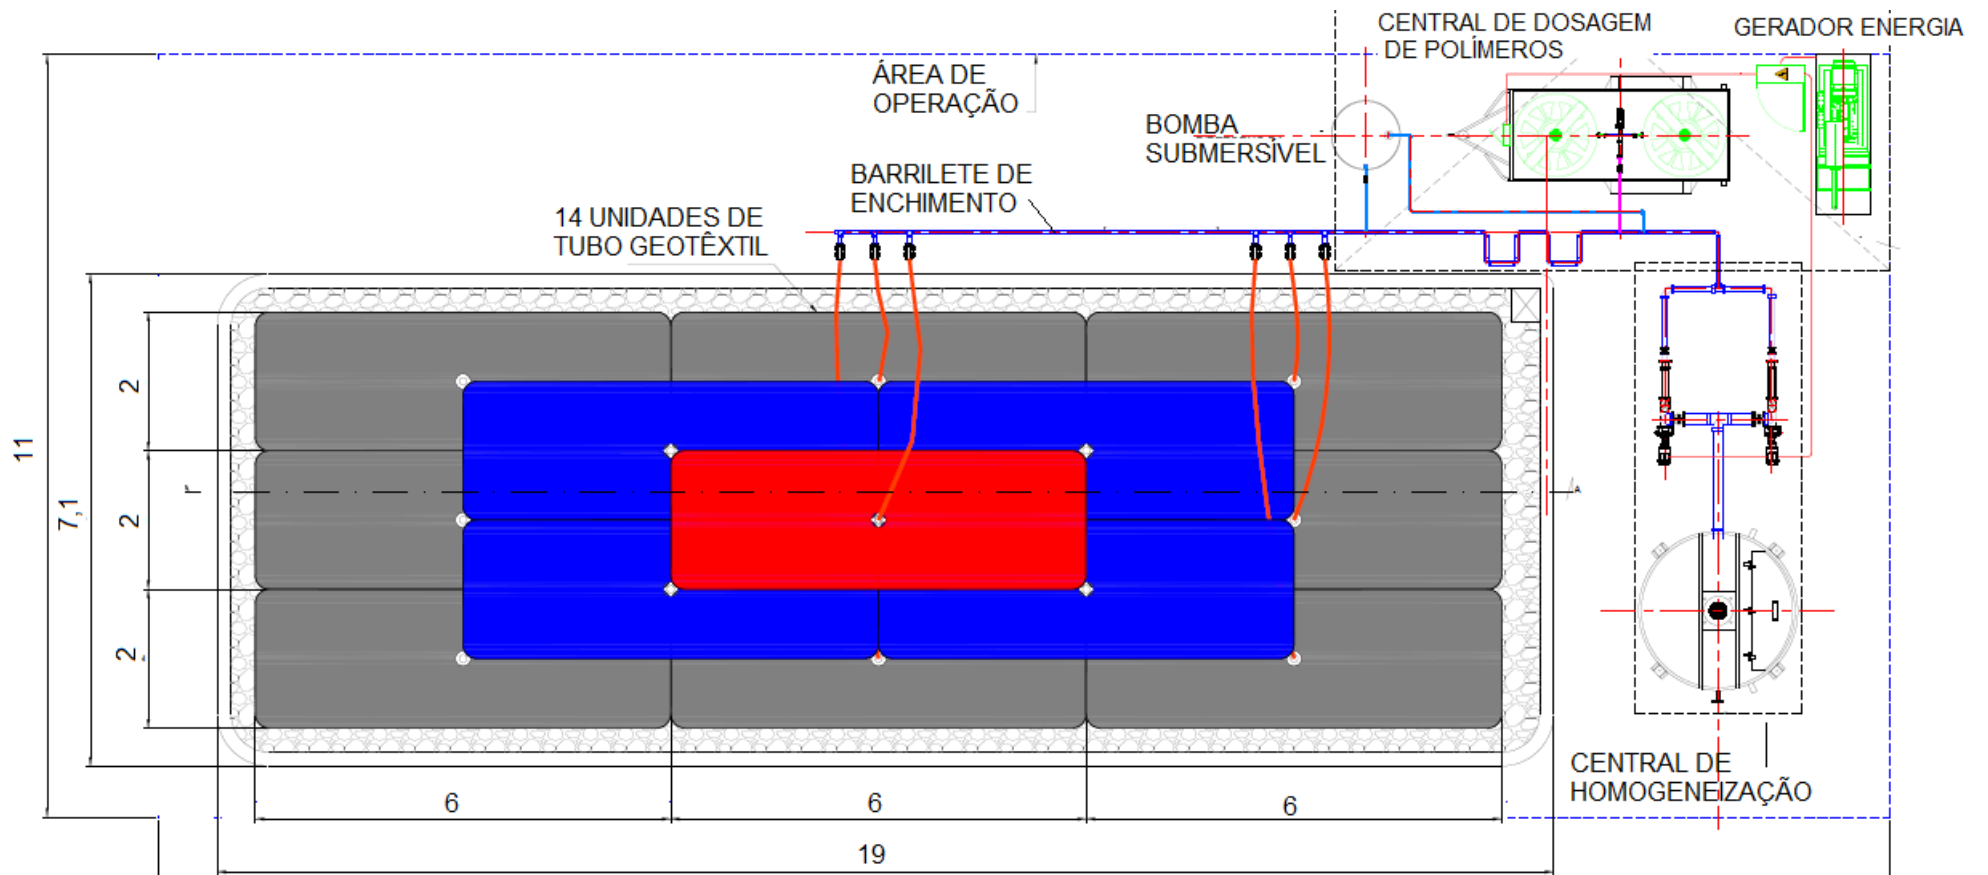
Layout do empilhamento de protótipos em grandes dimensões executado em campo.
